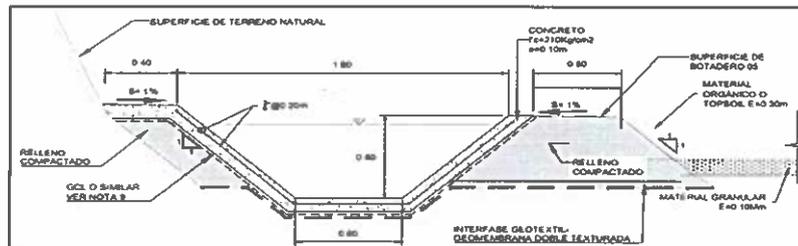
Sección típica de canal de colección-Botadero BD-SR-05
